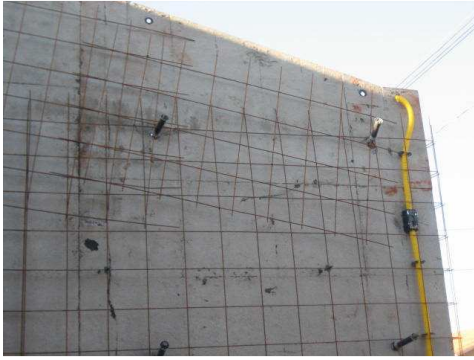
Fôrmas de vedação: detalhe da aplicação das telas de aço e instalações elétricas.
